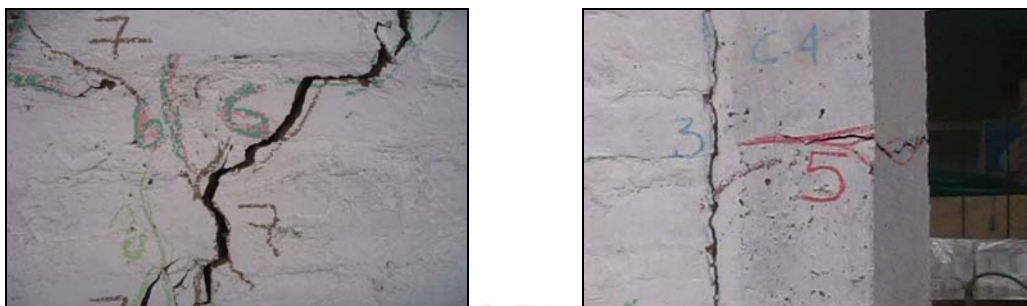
Grosos de grietas en el muro y en la columna derecha.
